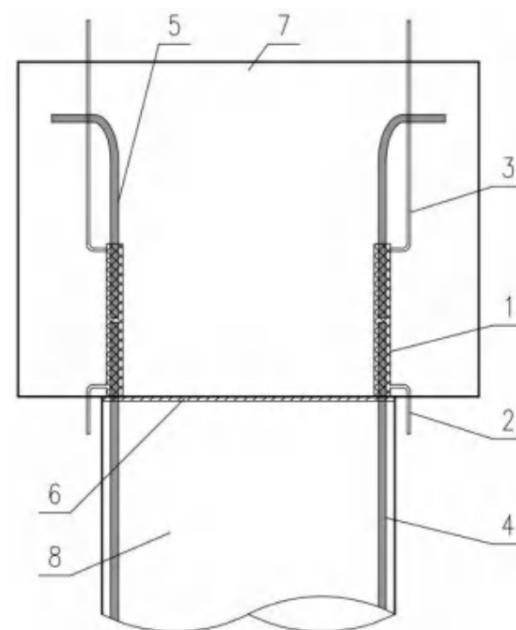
墩柱与盖梁钢筋灌浆套筒连接典型构造示意图
